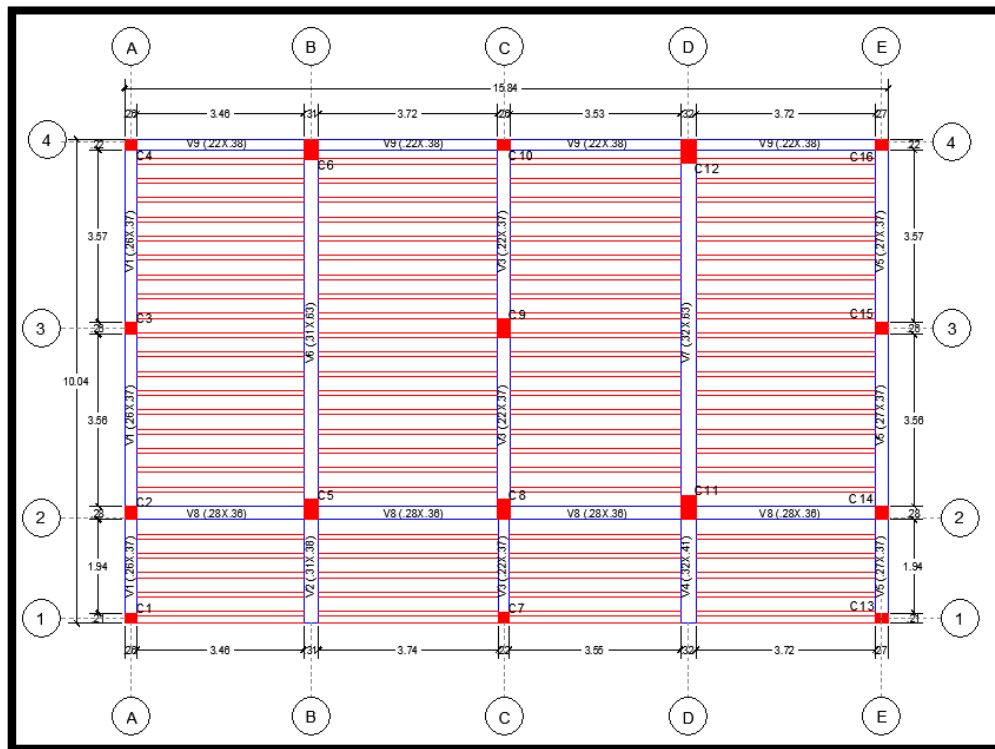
Plano de detalle de acero en losa aligerada – primer nivel
